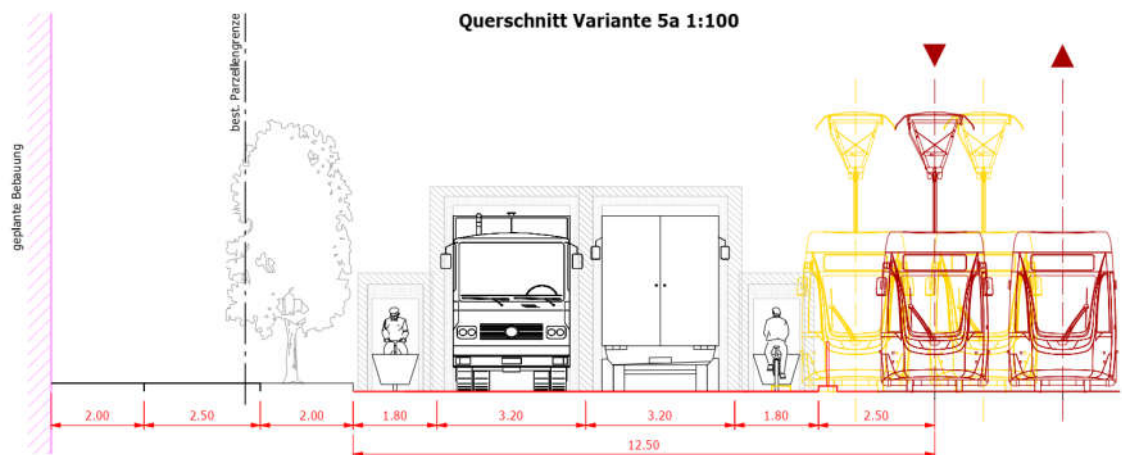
geplante Tramverlegung mit teilweiseem Erhalt der Baumallee an der Münchensteinerstrasse, Stand Vorstudie Dezember 2022
